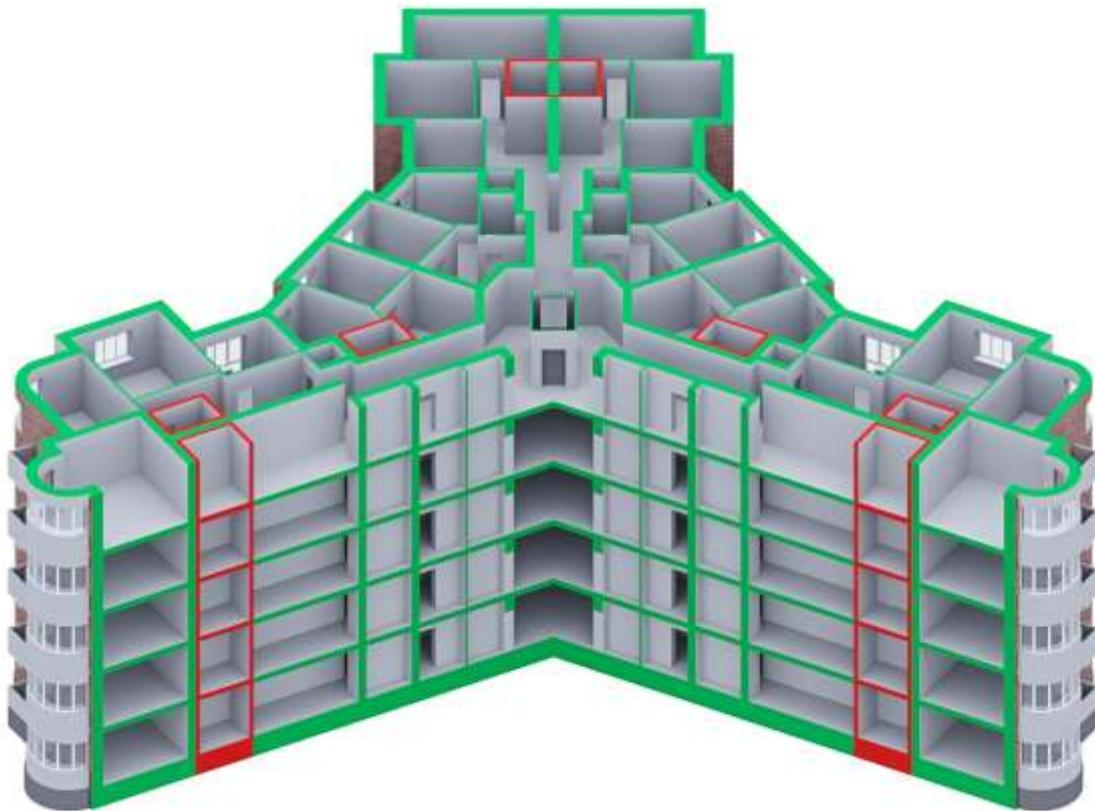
Загальний вигляд розрізу житлового багатоповерхового будинку з вбудованими захищеними приміщеннями
